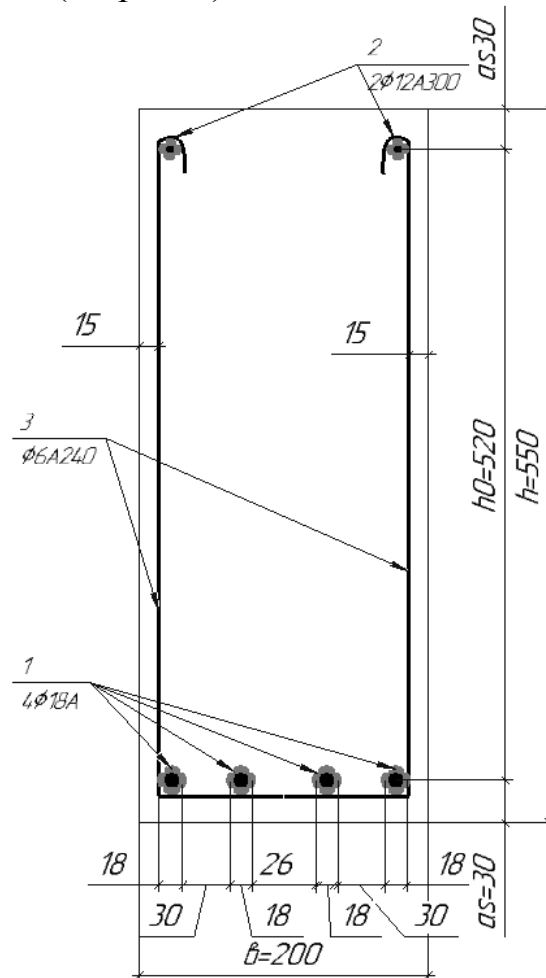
Конструювання прямокутного поперечного перерізу залізобетонної балки з одиничним армуванням
